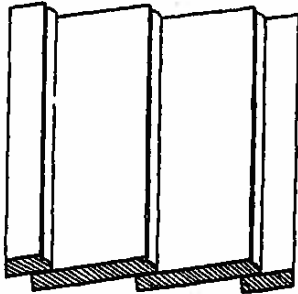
Horizontalt trepanel, supanel med høyde kantprofil.
